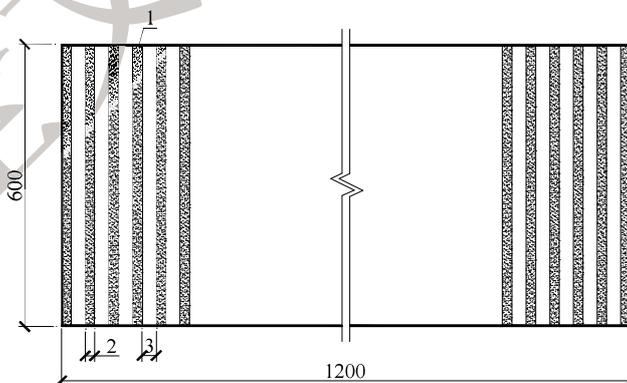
条粘法示意（尺寸单位：mm）
